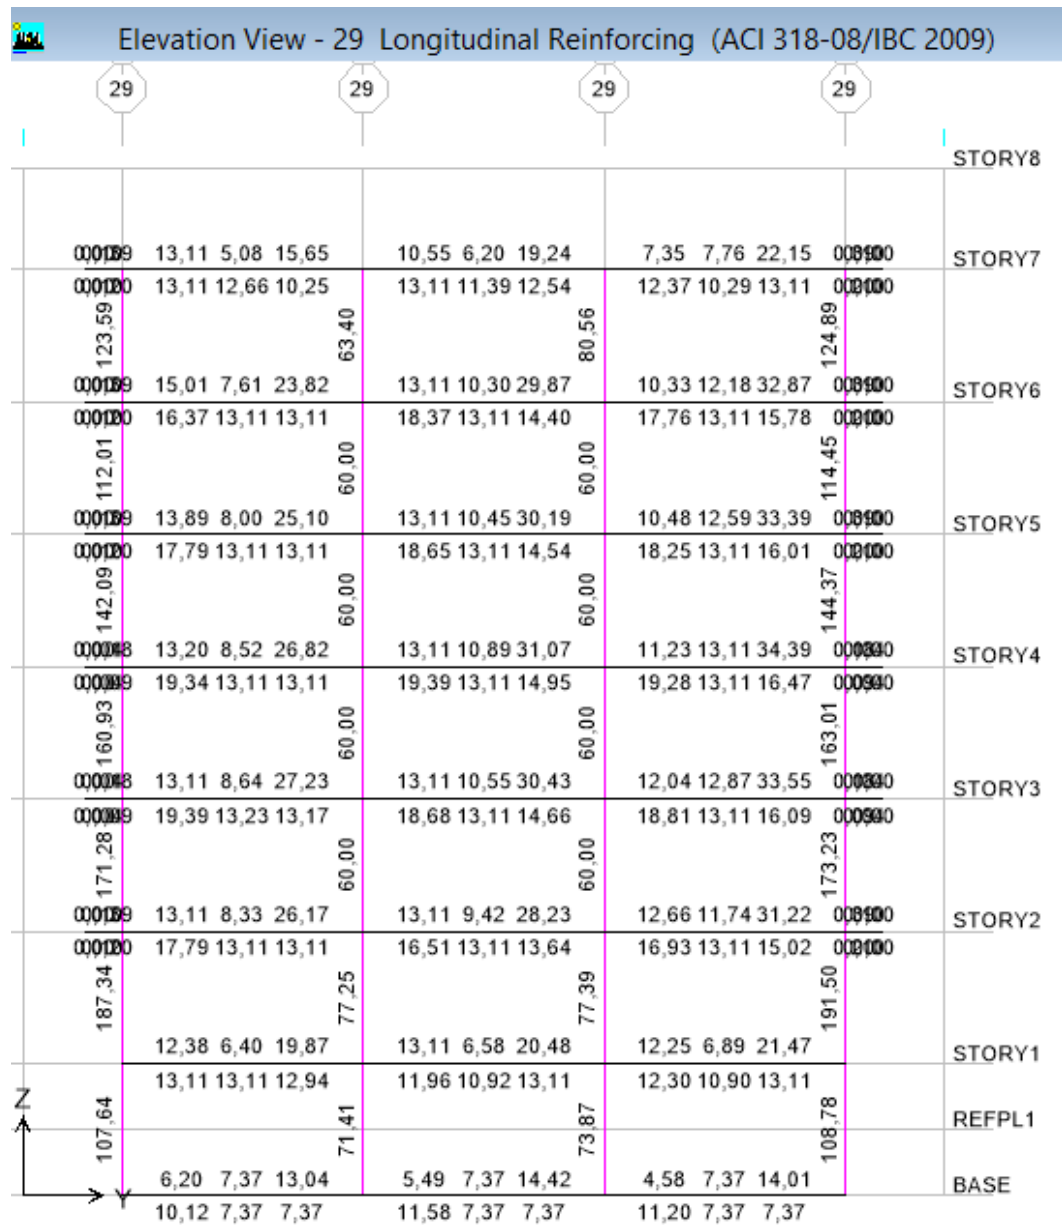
Acero en Vigas y Columnas en el Pórtico 29 – Hospitalización 2- (LRB+HDR)
